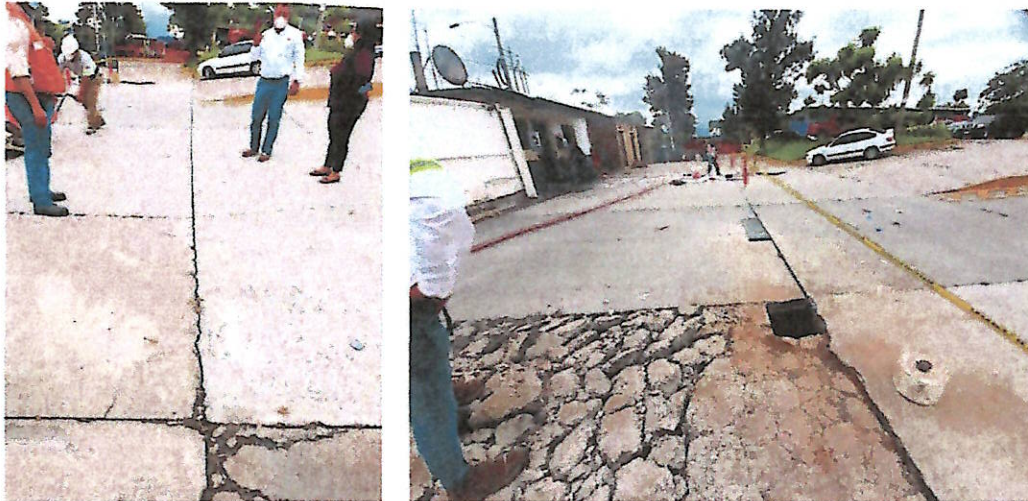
Vista de desplazamiento en junta de muro perimetral de predio de Cervecería Centroamericana.
